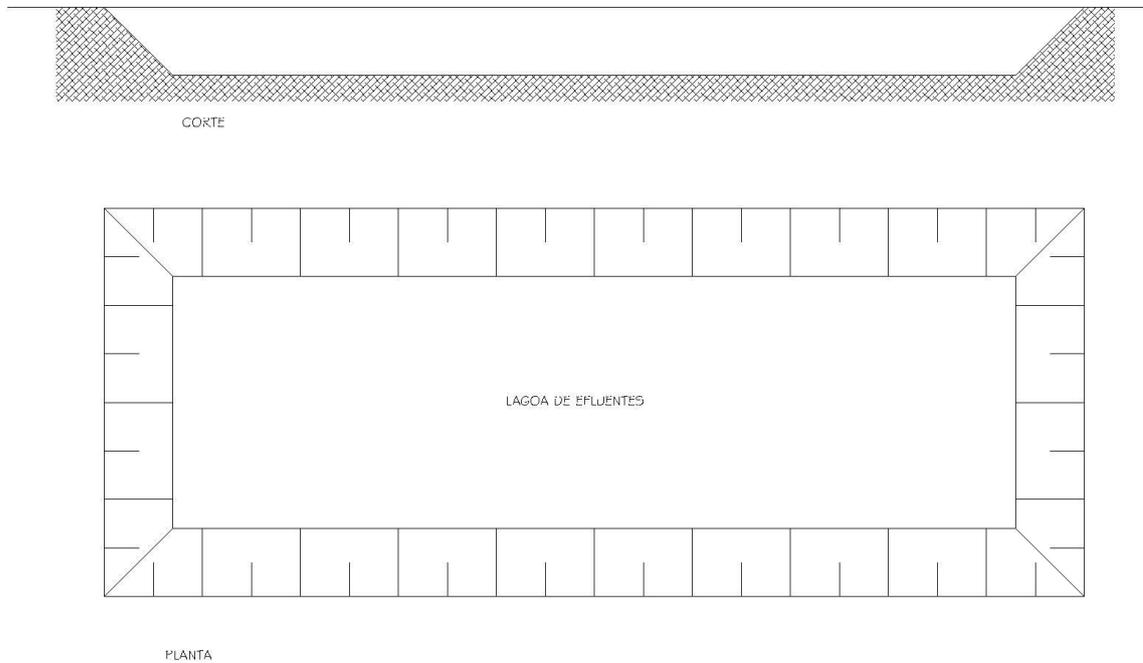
Lagoa de Efluentes (Planta e Alçado) (Desenho 7)
